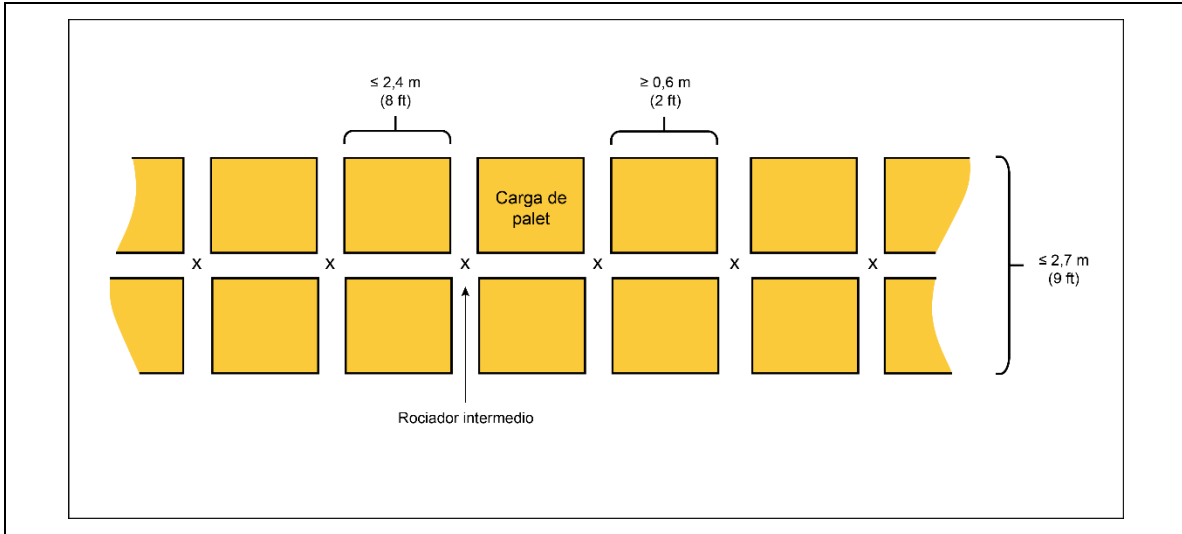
Vista en planta de una configuración horizontal de rociadores intermedios en cada chimenea transversal para estanterías dobles con una profundidad máxima de 2,7 m (9 ft)
